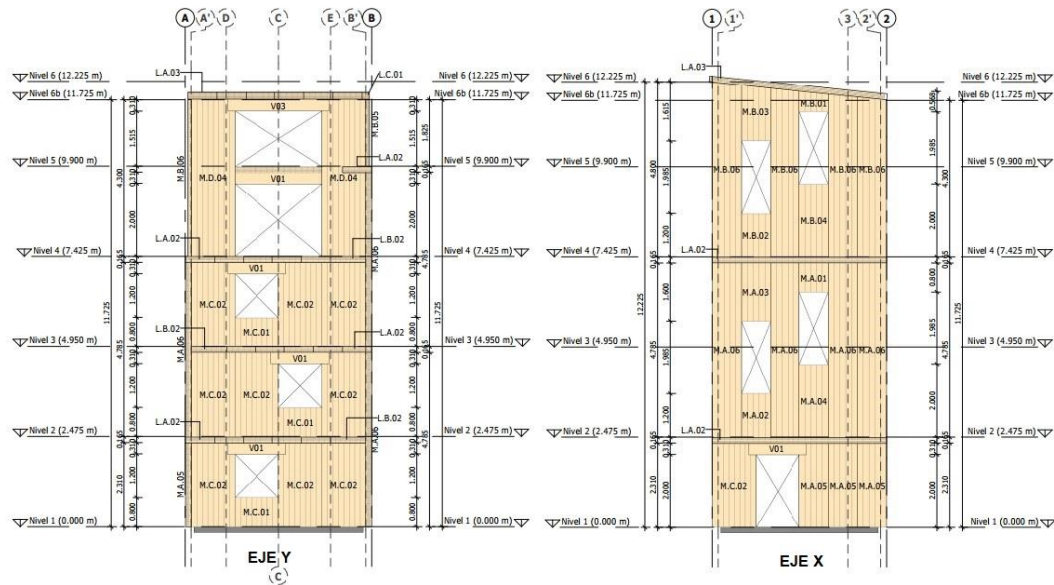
Elevación de Muros Perimetrales (Elaboración propia)
